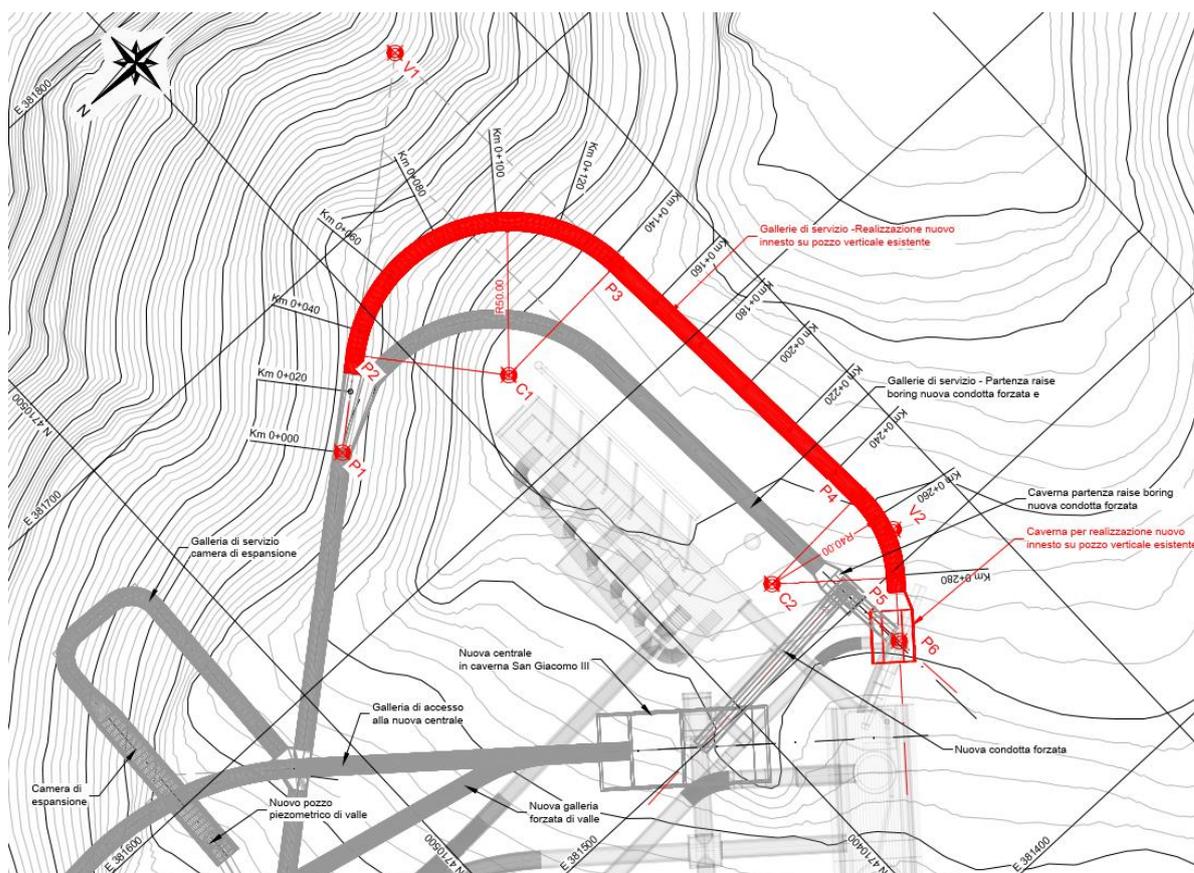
Zona della nuova caverna centrale, particolare dell'innesto e della caverna.
